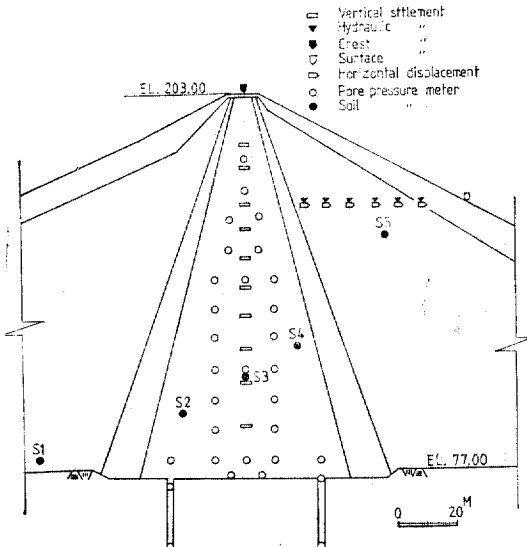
Instrumentation at Maximum Cross Section (St. No. 12+7).
